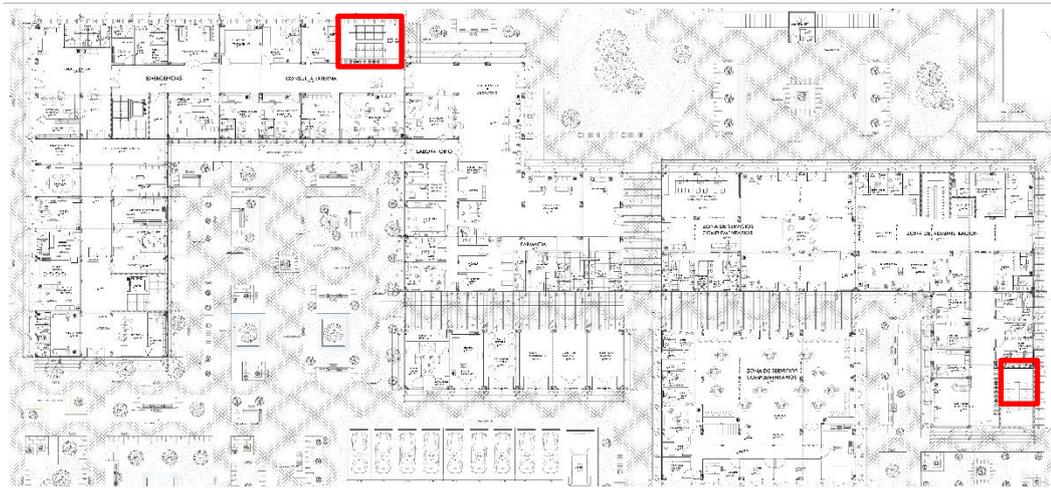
Escaleras de evacuación s -Planta arquitectónica del primer nivel
